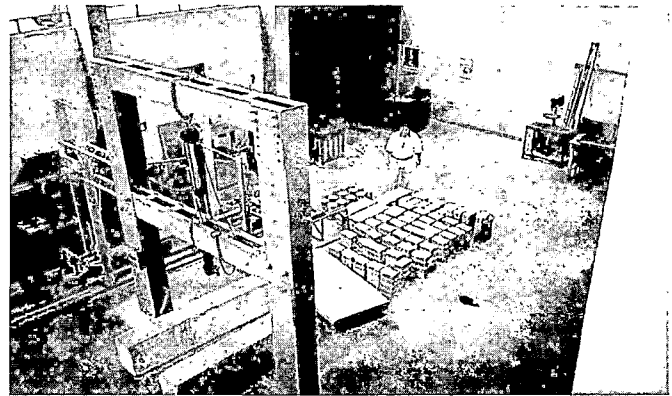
PANEL DE FOTOS DE LAS PILAS Y DEL ENSAYO DE
